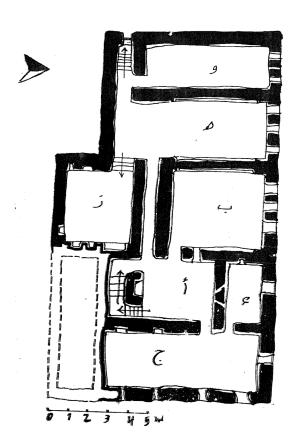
منزل الشريف عبد المطلب الدور الأول – مسقط أفقى
